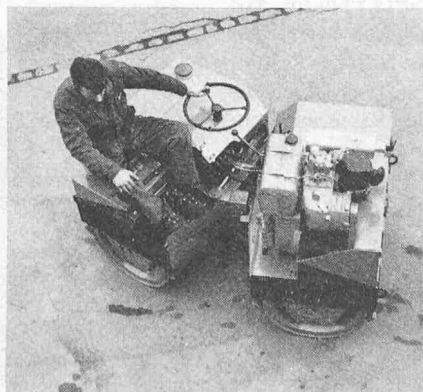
Doppel-Tandem Vibrationswalze DTV-42, Gewicht 4400 kg, Walzendurchmesser 920 mm, Walzenbreite 1230 mm, Mittelpunktklenkung-Doppelantrieb
